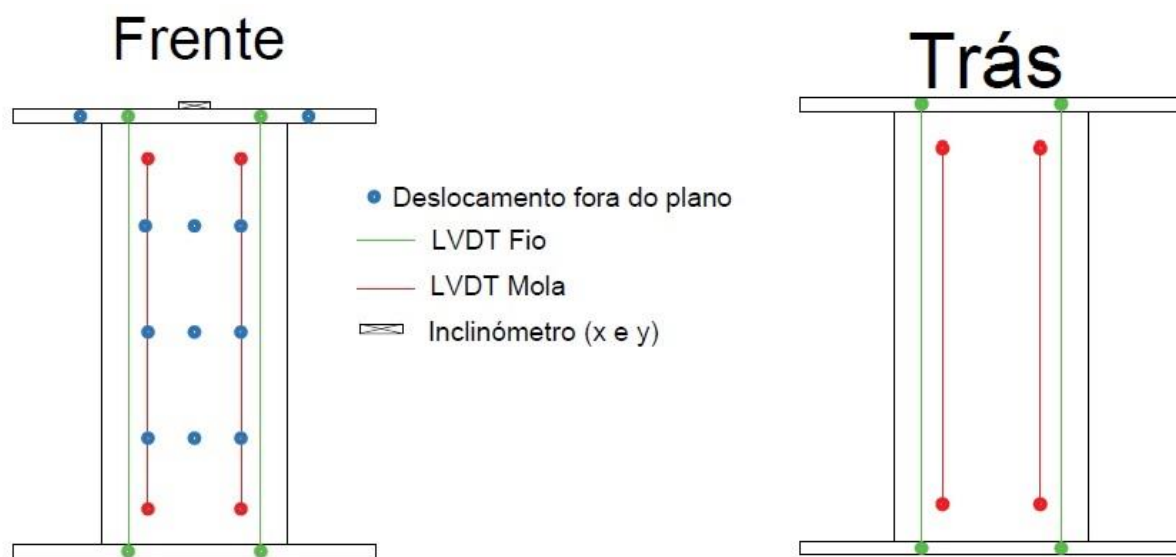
Disposição de LVDTs da Parede 3, Fase 4 compressão
